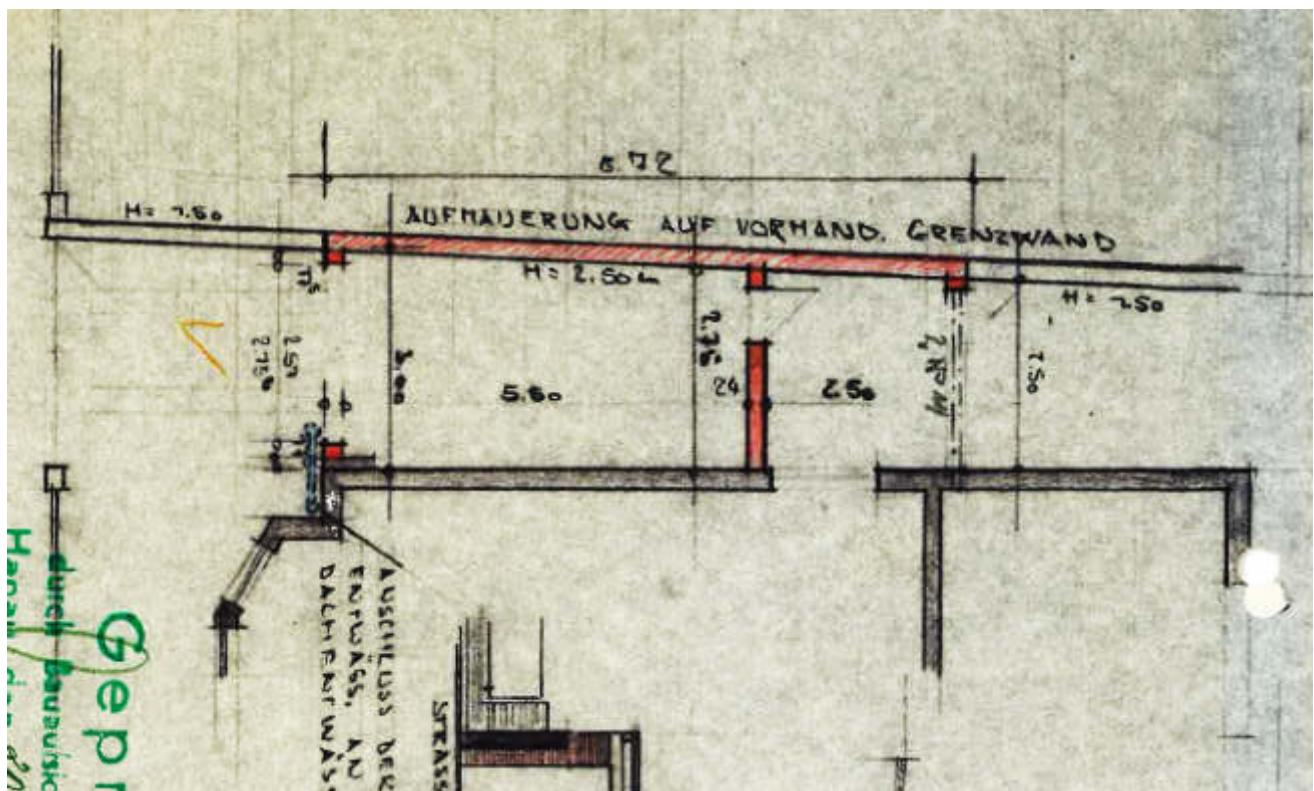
Grundrissplan Garage (ohne Maßstab) von 1975; Quelle: Bauakte der Stadt Hanau
